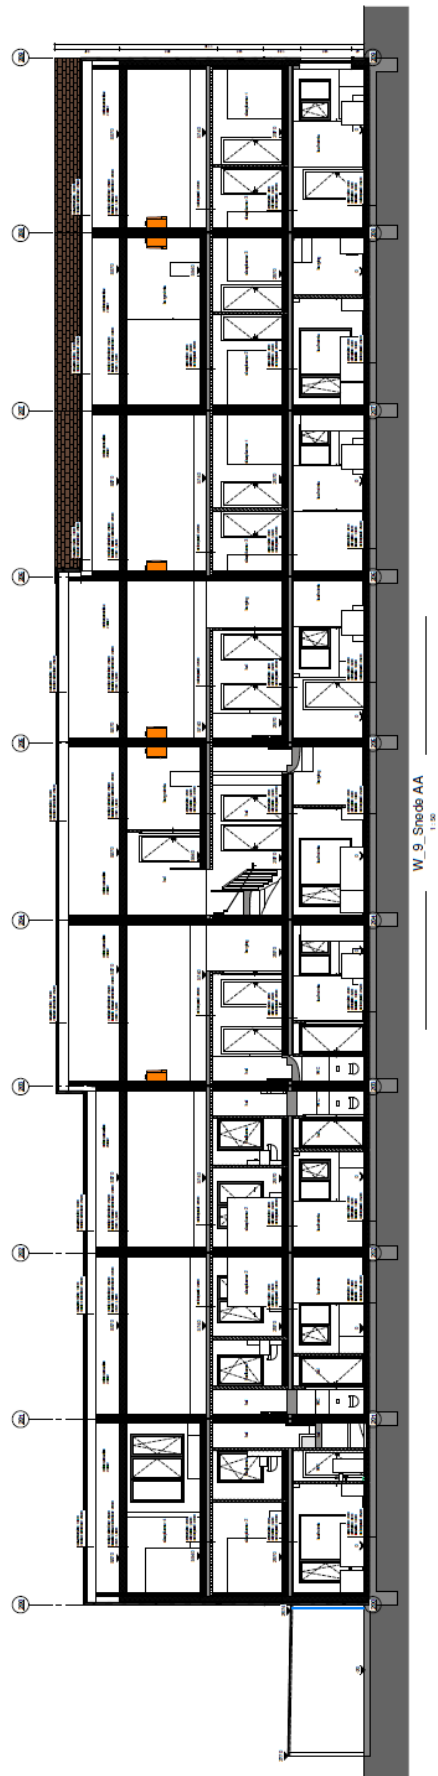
Doorsnede van het appartementsgebouw met ondergrondse parking (Bron: opdrachtgever).
